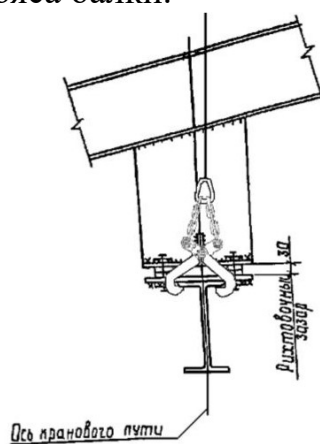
Монтаж подкрановой балки клещевыми грузозахватными приспособлениями
